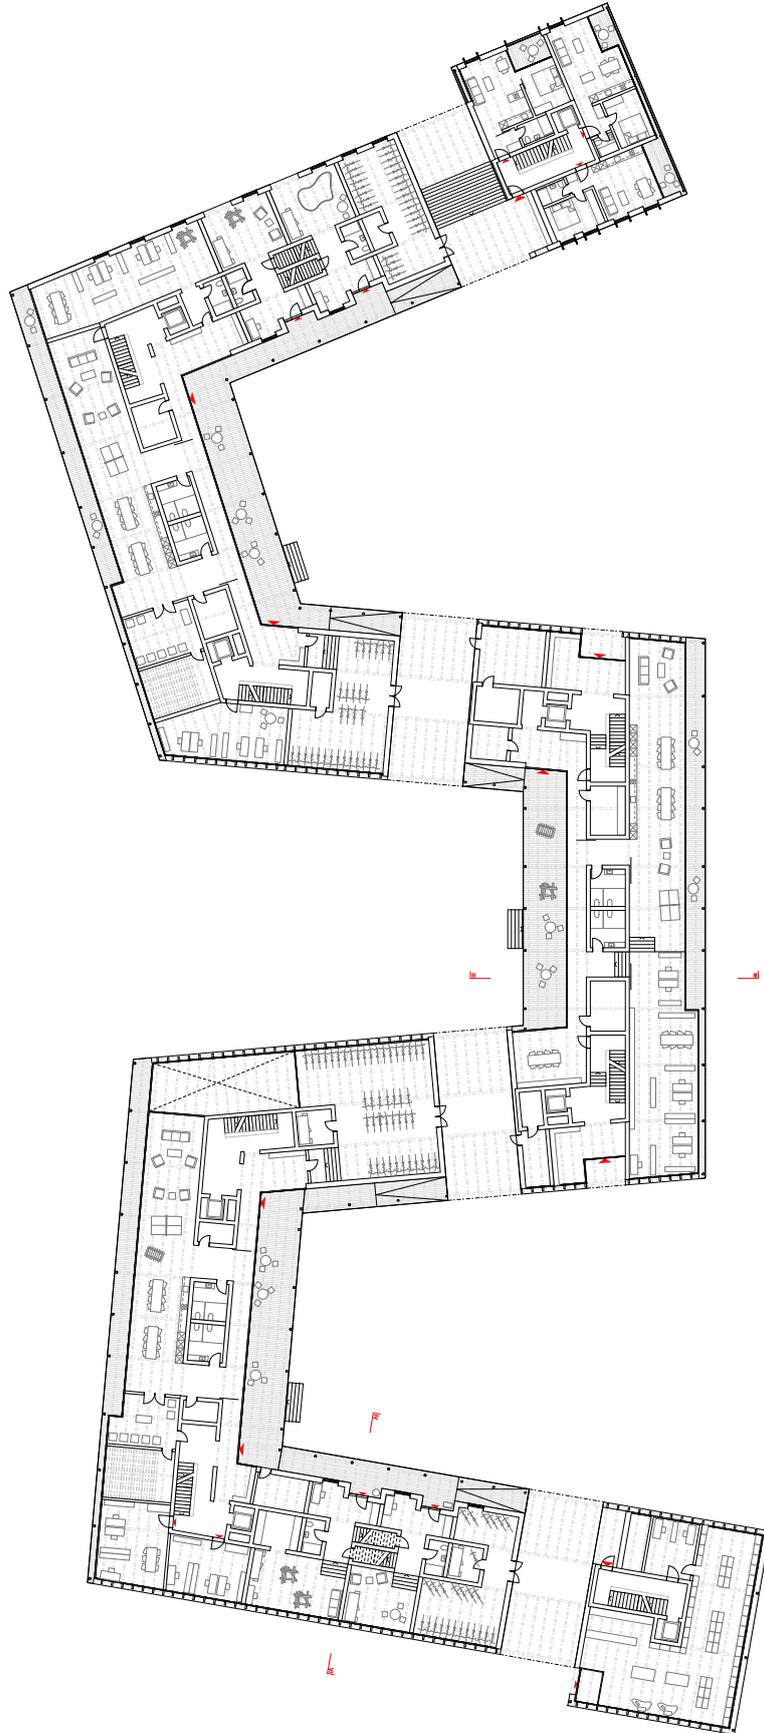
Grundriss Erdgeschoss 1:600
